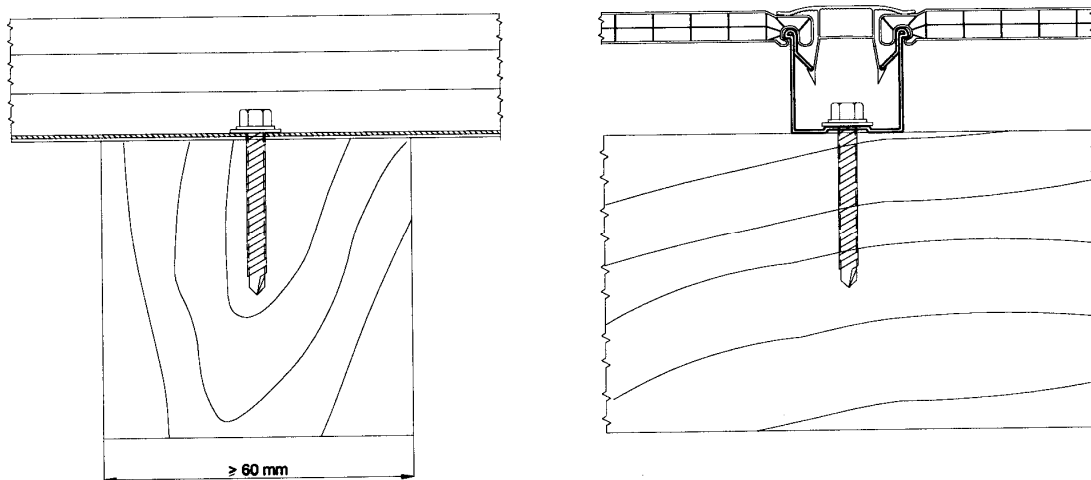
Fixation d'extrémité ou intermédiaire du porteur standard sur support bois
